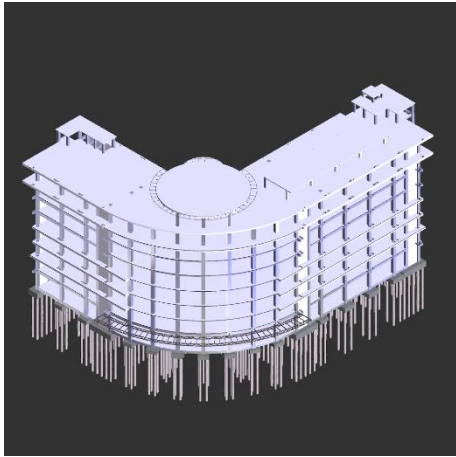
Hasil Pemodelan 3D Struktur Beton
